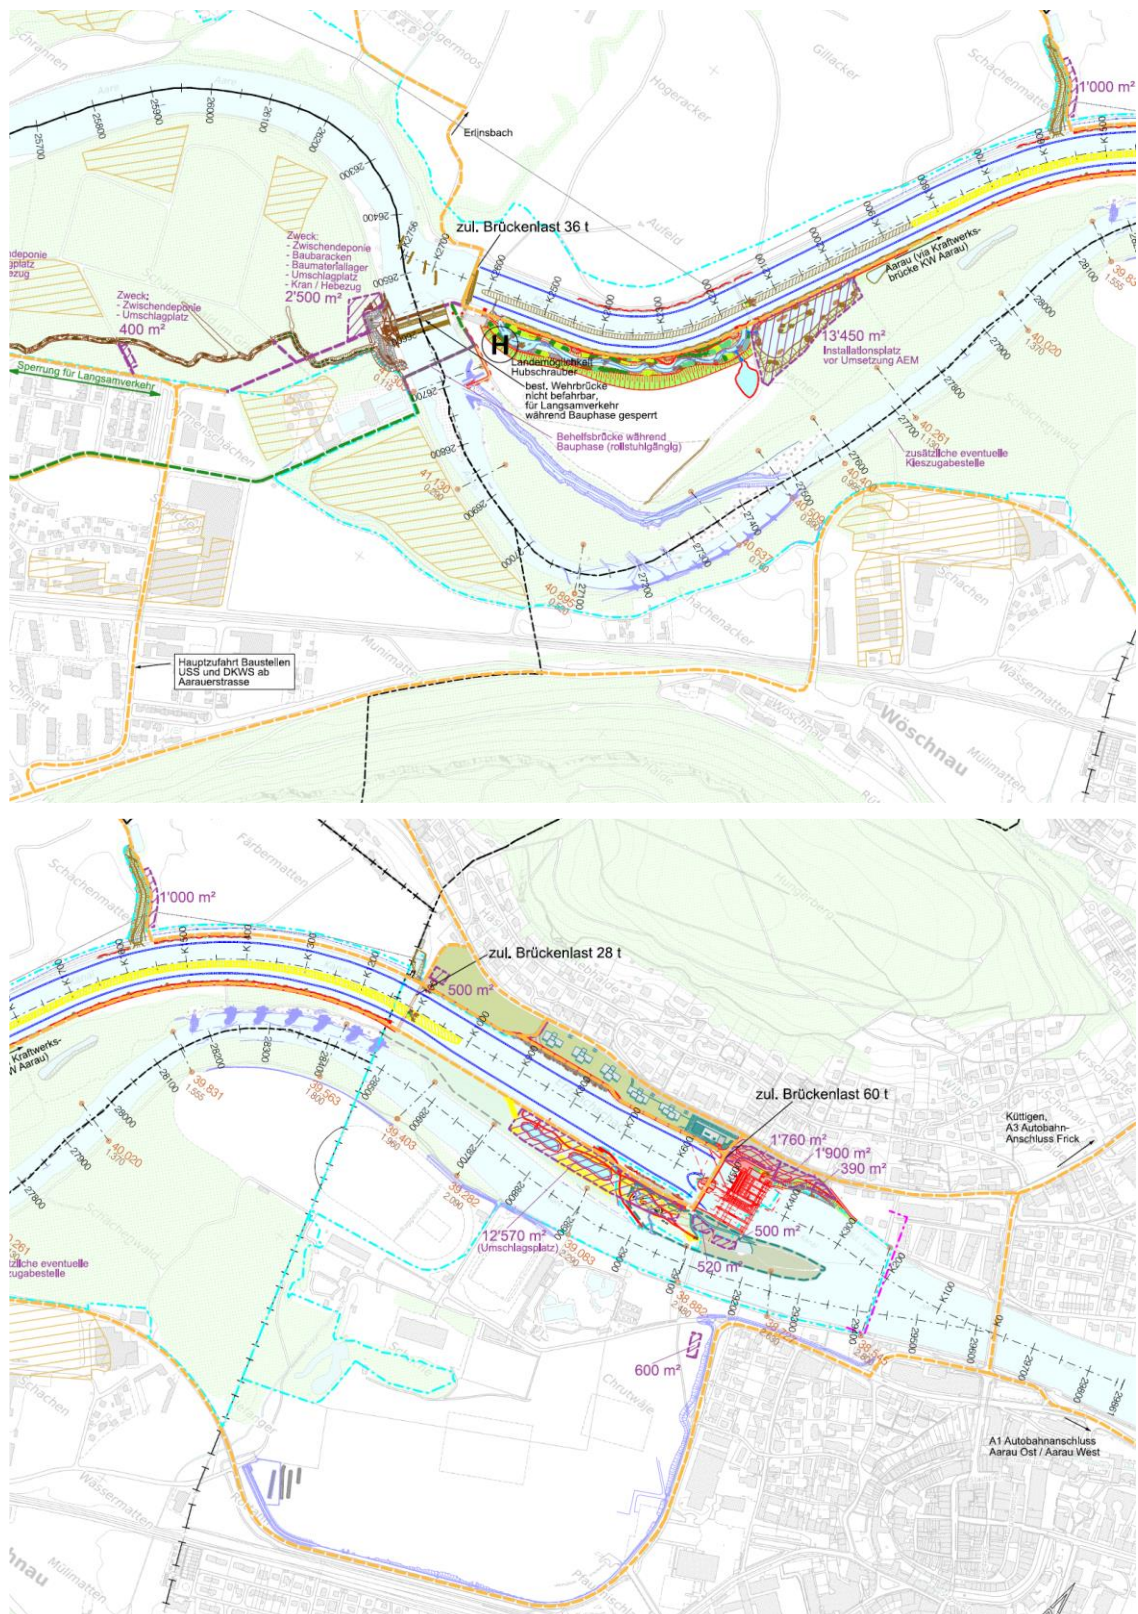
Erschliessung Baustellen: 2 Ausschnitte aus Erschliessungsplan Baustellen und Installationsplätze. Der Baubereich im Schachenwald Schönenwerd ist nicht umfassend dargestellt, da die dort bereits bewilligten Bauten ab Sommer 2020 realisiert werden.
